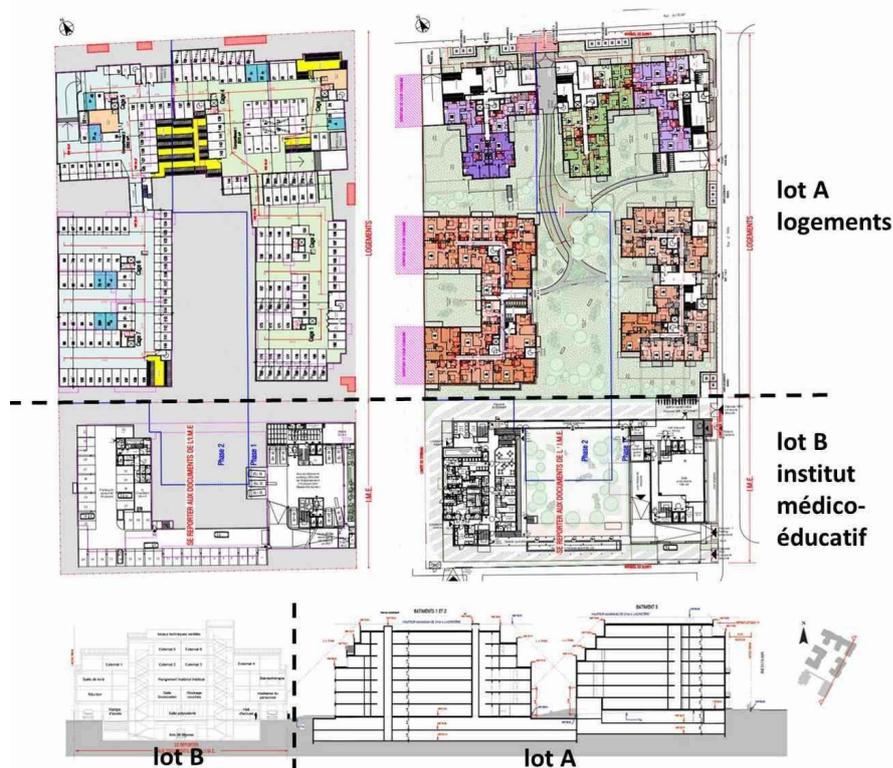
Plan du premier niveau de sous-sol, plan du rez-de-chaussée et coupe nord-sud (source : permis de construire A02, A03 et C03). En comparant à l'état actuel (Figure 2), il est constaté l'importante augmentation des hauteurs du bâti et des surfaces artificialisées.
